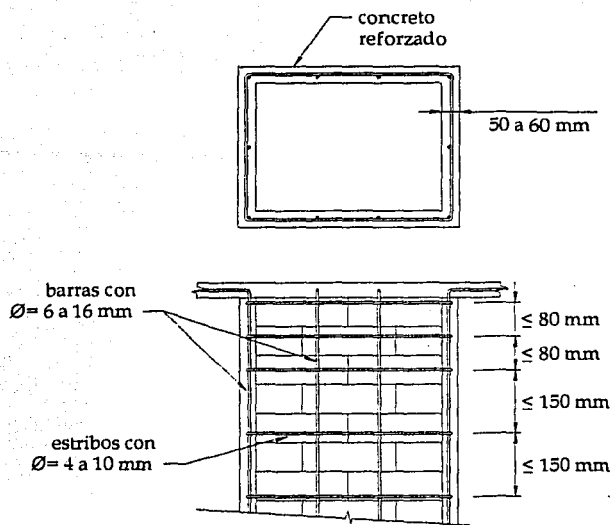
Reforzamiento de columnas de mampostería con recubrimiento de concreto reforzado (Pume, 1989).
